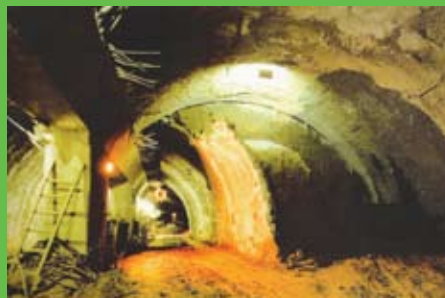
Vista do interior da Estação Vila Madalena durante a escavação, Metrô de São Paulo (CBT – 2006)
